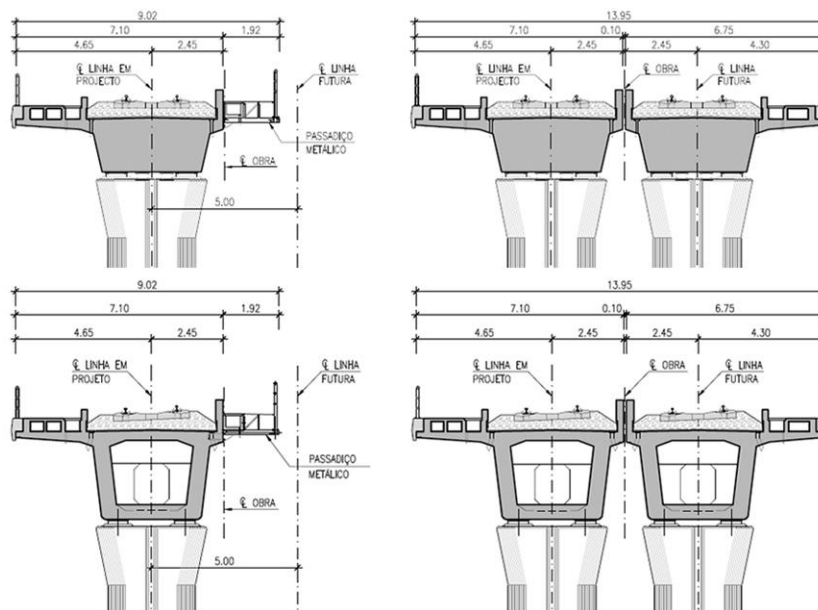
Secções transversais tipo (em cima para pontes até 35m de vão; em baixo para a Ponte do Freixo, com 45m de vão; do lado esquerdo, obras já executadas; do lado direito configuração após futura duplicação).
